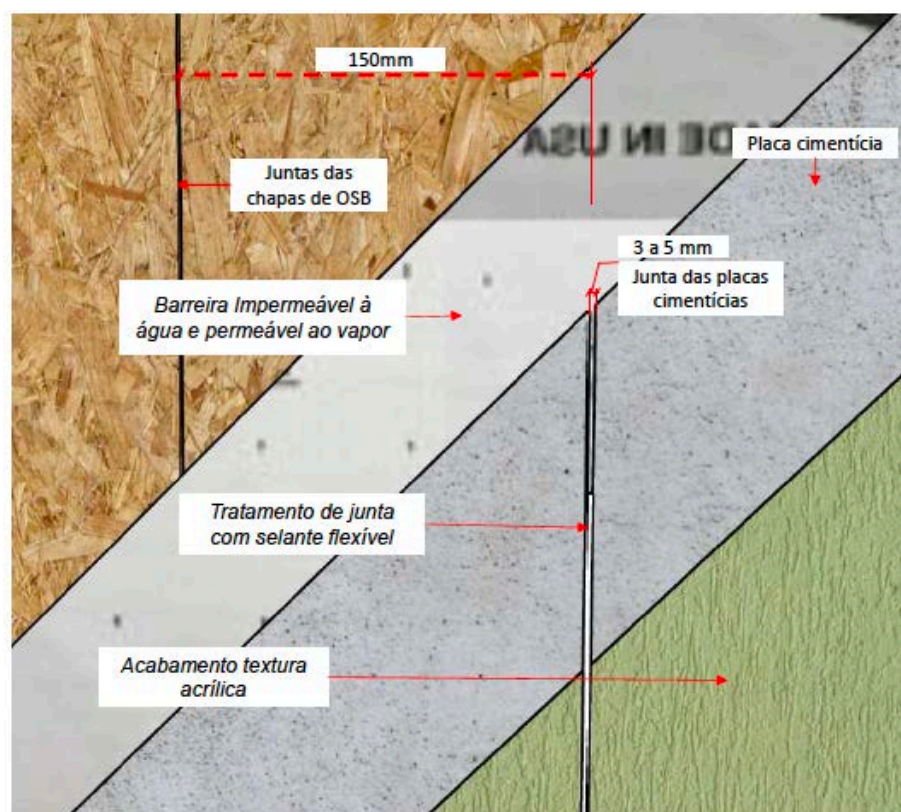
Detalhe da junta aparente entre placas cimentícias.
